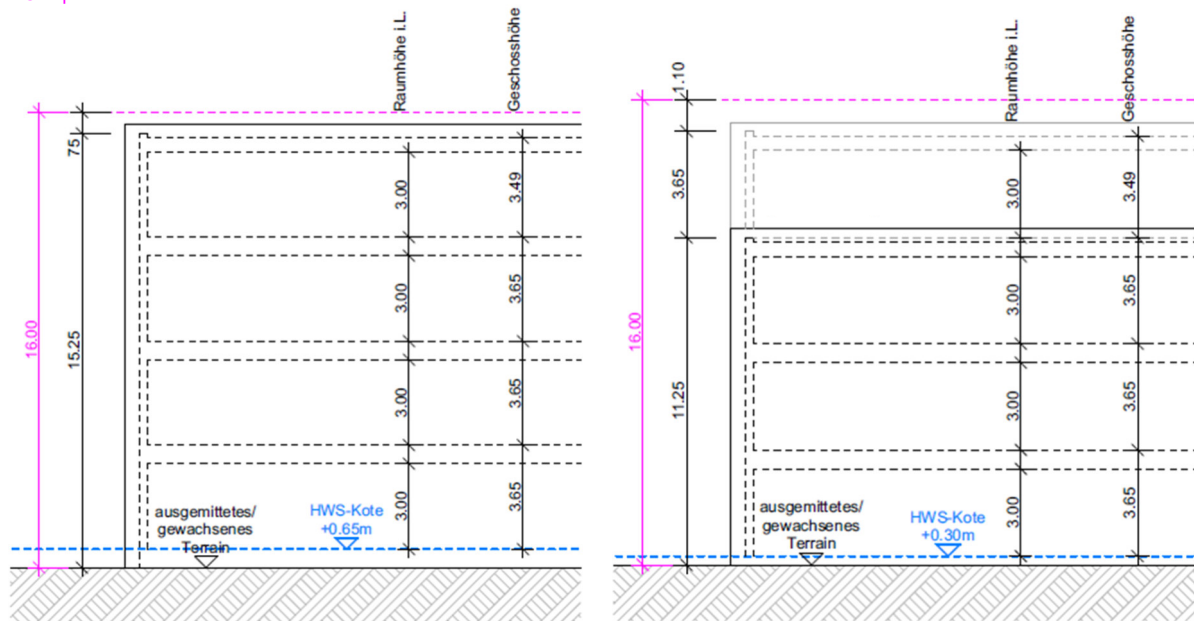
Campus B: Fassadenhöhen. Links: Neubau Oberstufe, rechts: Neubau Primarschule
